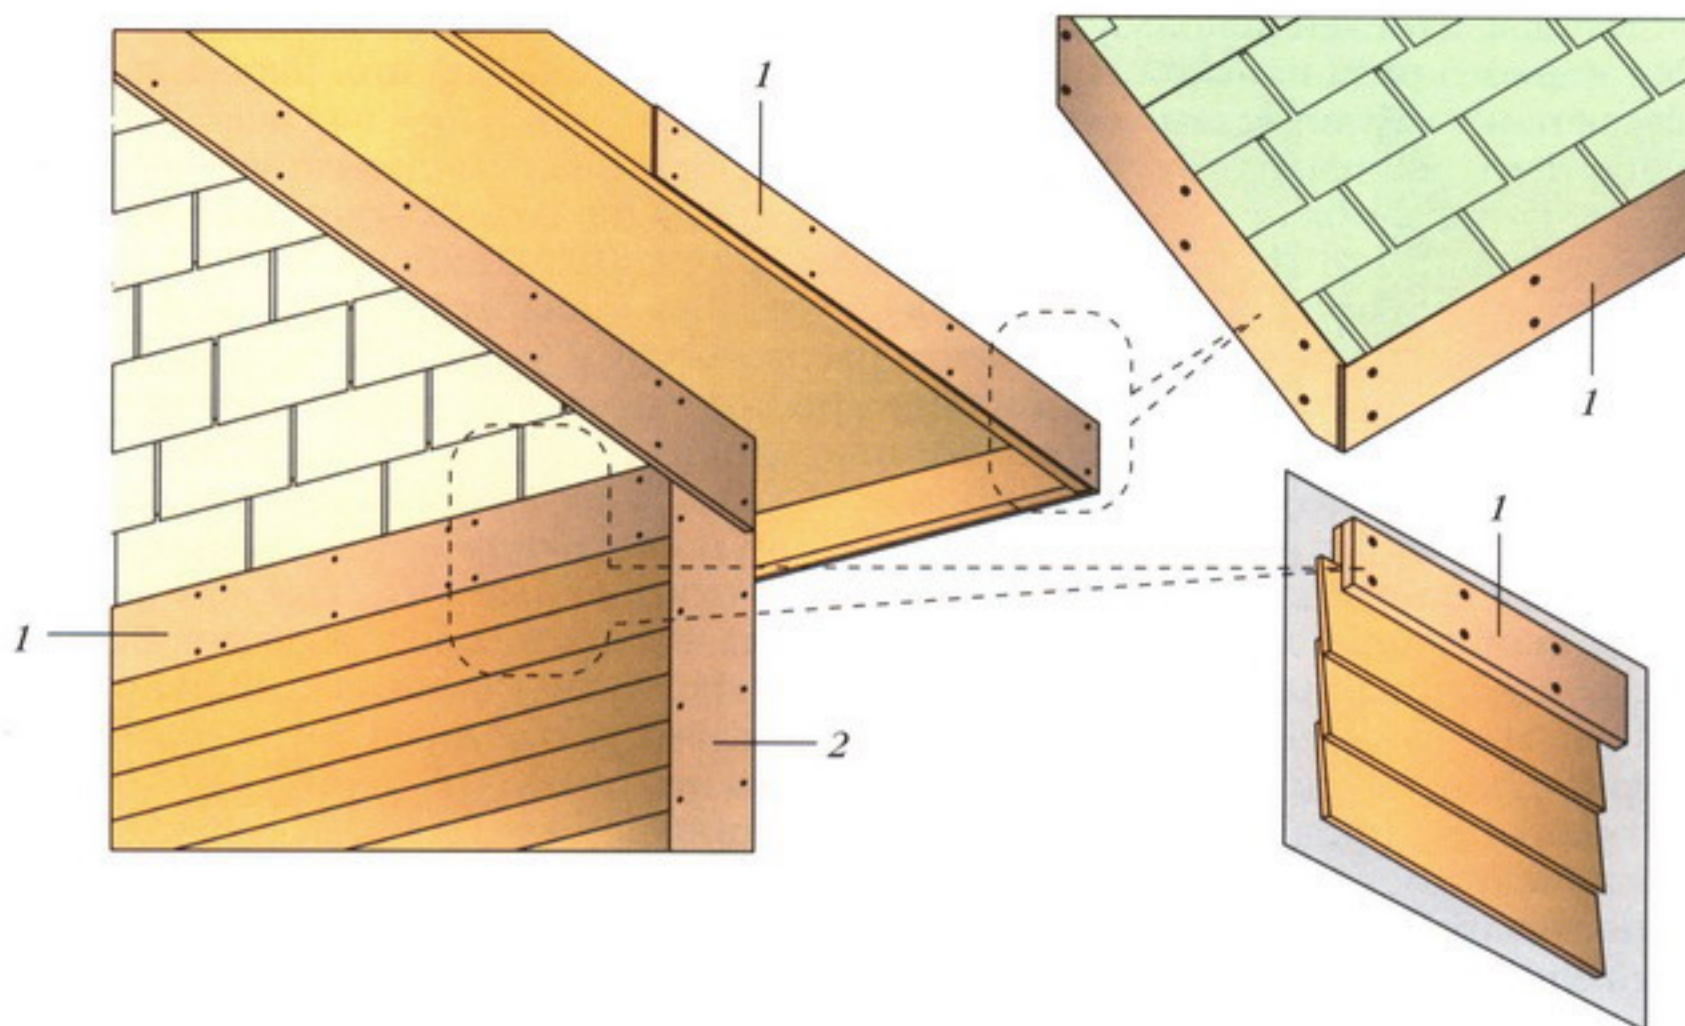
Монтаж погонажного сайдинга на карнизах крыши: 1 — фаска; 2 — наружный угол
